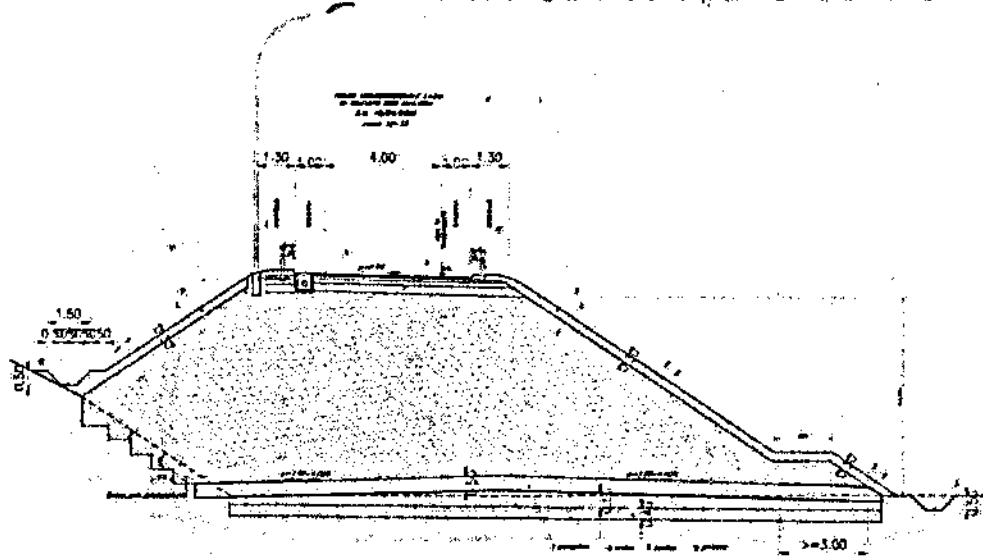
Sezione tipo rampa monodirezionale in rilevato alto
